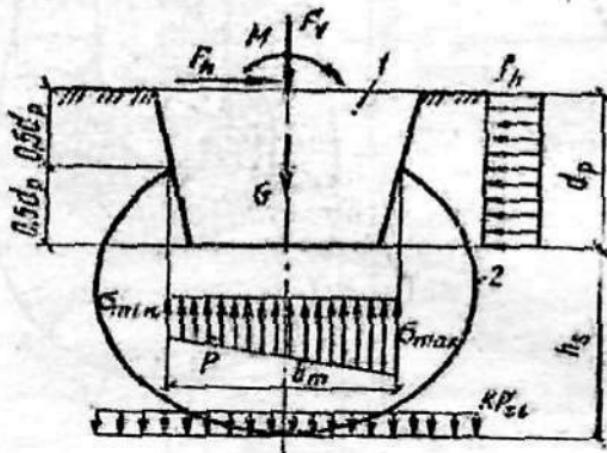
Схема к расчету столбчатого фундамента в вытрамбованном котловане
